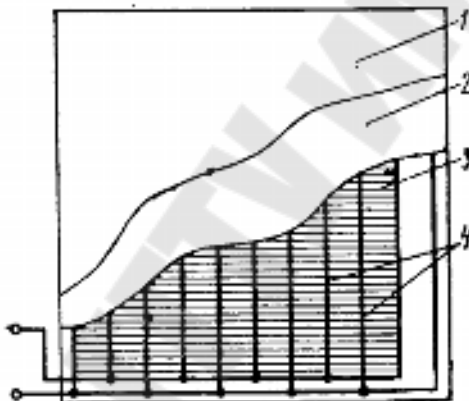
Принципиальная схема ПЭН, совмещенного с конструкцией ЭТУ-коврика: 1 – контактная поверхность нагрева; 2 – стеклоэмалевая изоляция; 3 – токопроводящая пленка нагревательного элемента; 4 – контактные электроды в виде полос
